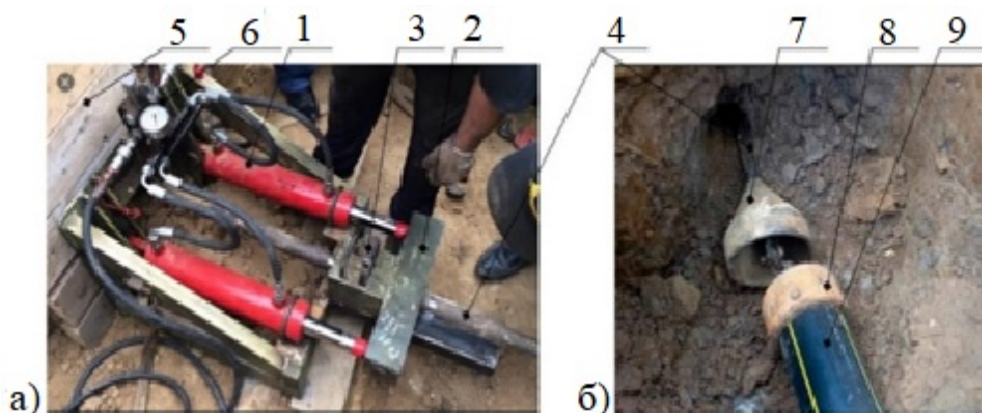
Прокол і розширення ТПГ: а) – пілотне або стартове проколювання ґрунту; б) – поступове розширення порожнини конусами: 1 – силова установка; 2 – упорна балка; 3 – ключ-стопор; 4 – штанги; 5 – упорний майданчик; 6 – гідророзподільник; 7 – розширюючий РО; 8 – захват труб; 9 – труба
